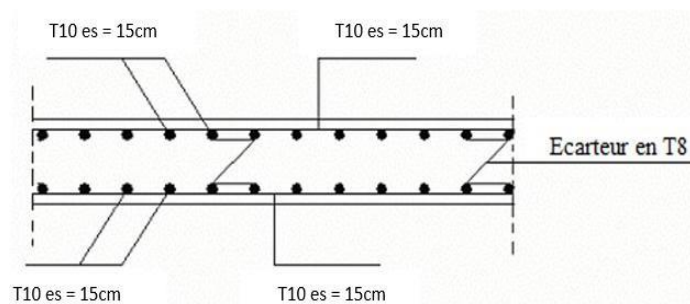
Ferrailage de la dalle pleine rectangulaire
